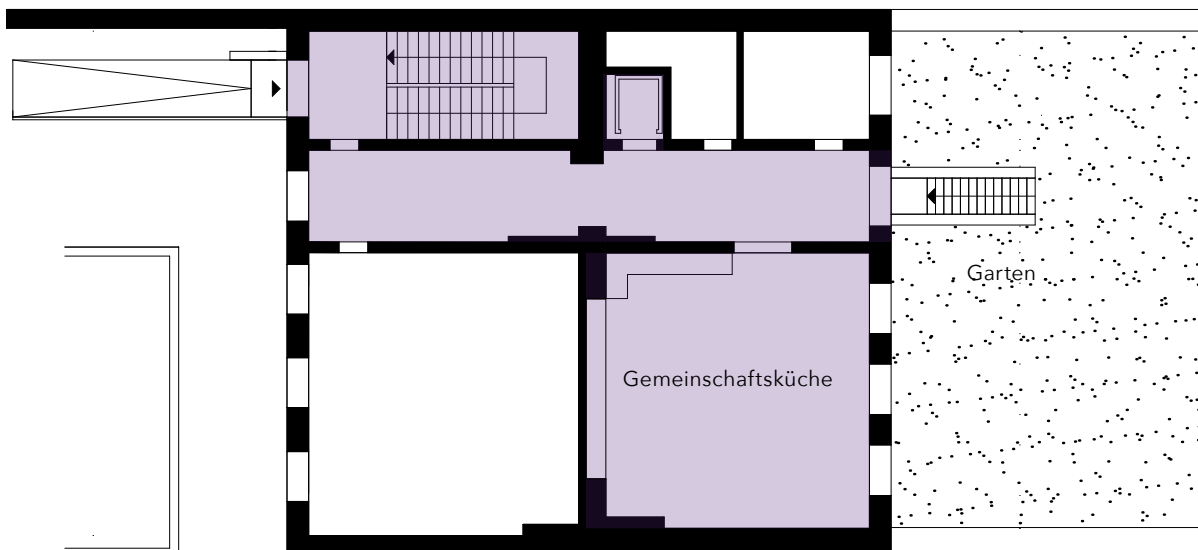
Intersektionales Stadthaus, Gemeinschaftsküche; Grundriss Erdgeschoss, M 1:200
